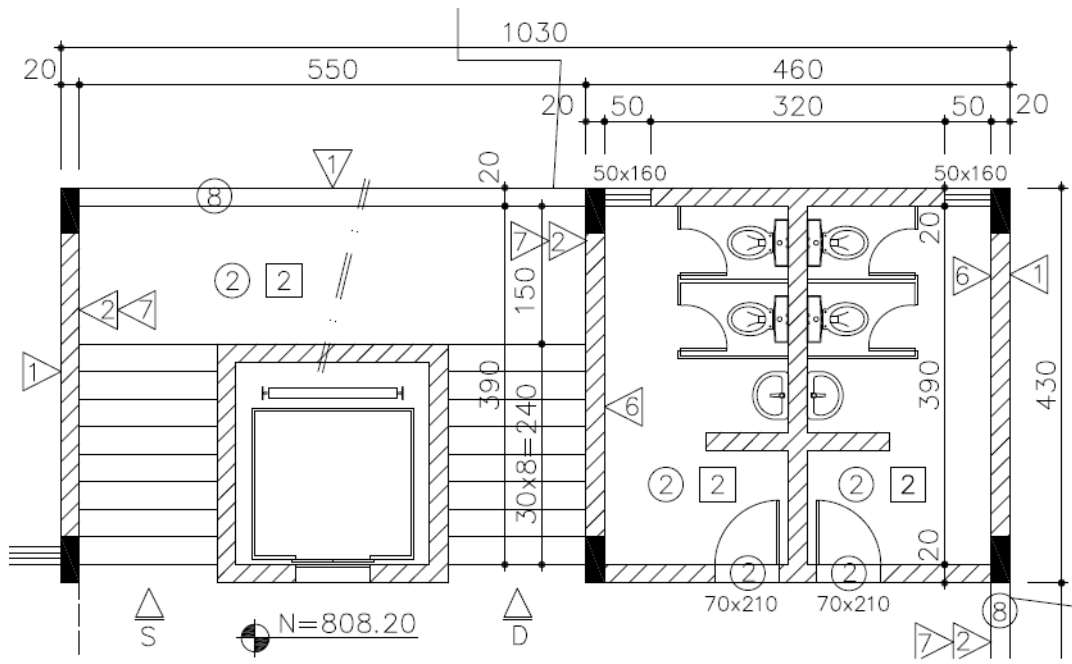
Aberturas da elevação norte do bloco secundário em uma primeira concepção, vistas em planta.
